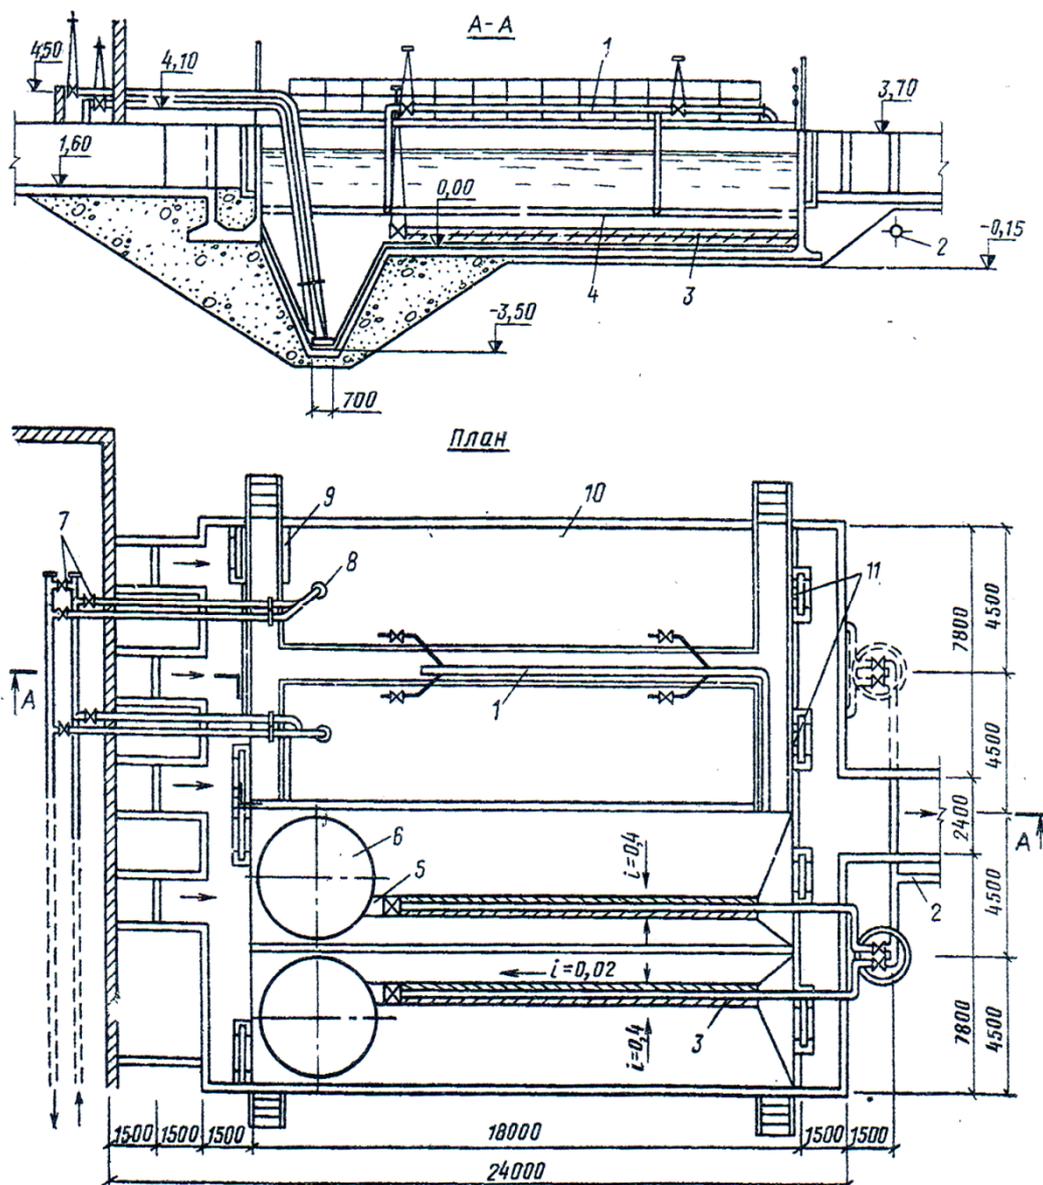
Аэрируемая пескочистка с гидромеханическим удалением песка: 1 – воздуховод; 2 – трубопровод для гидросмыва; 3 – смывной трубопровод со sprысками; 4 – аэраторы; 5 – песковой лоток; 6 – песковой бункер; 7 – задвижки; 8 – гидроэлеваторы; 9 – отражательные щиты; 10 – отделение пескочистки; 11 – щитовые затворы.
